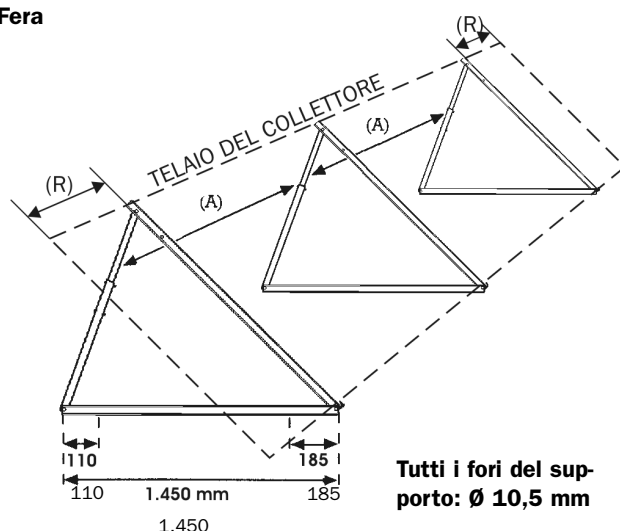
Distanza e numero dei supporti per SolvisFera (l'immagine mostra un'installazione su tetto piano; installazione a parete: i supporti devono essere ruotati di 90° in senso antiorario)
